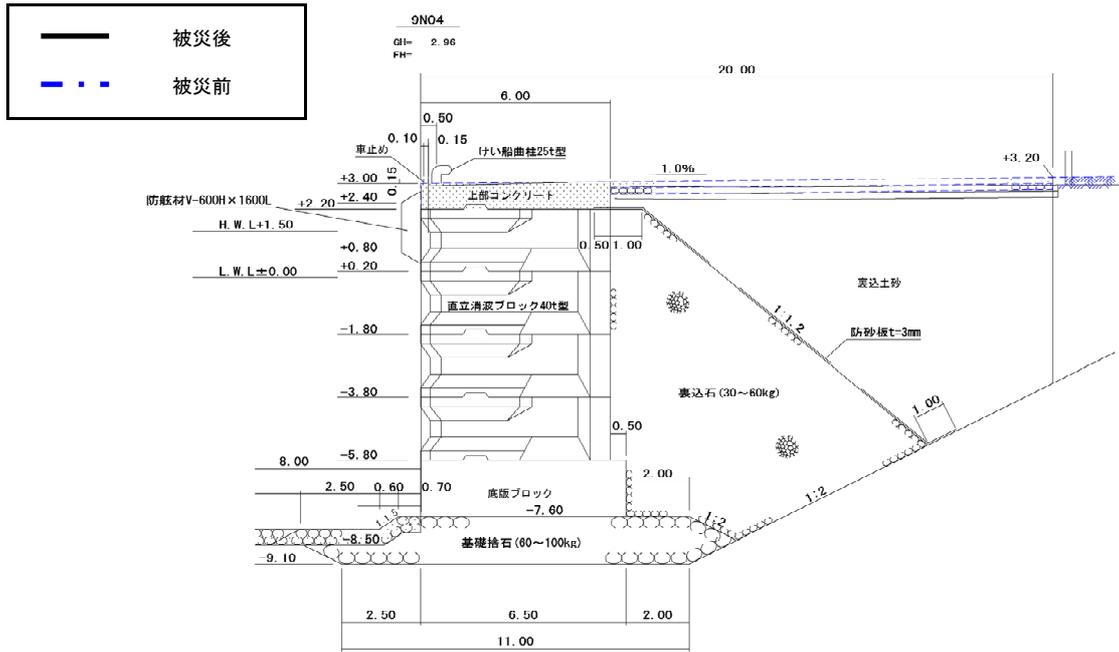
No.34 大洗港区_第3埠頭地区西岸壁 (-8m) の断面図 (被災後)
